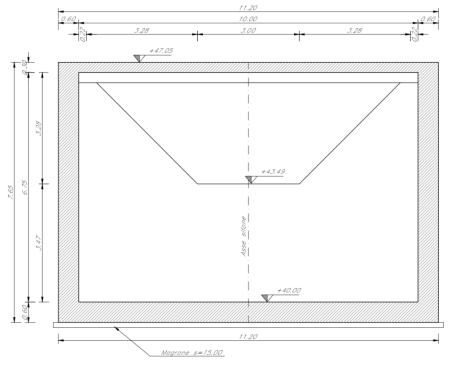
Sezione trasversale D-D – pozzo di risalita
